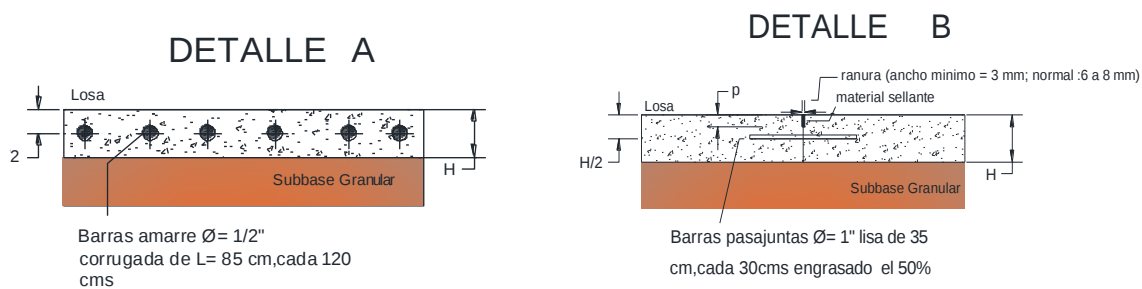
Detalles de Corte Modulación de Losa de Pavimento
